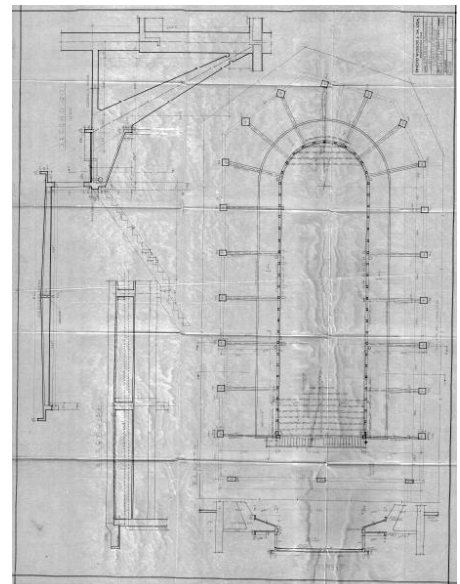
Planta Baixa laje cobertura 3º andar Magazine Mesbla, Porto Alegre, Brasil.
